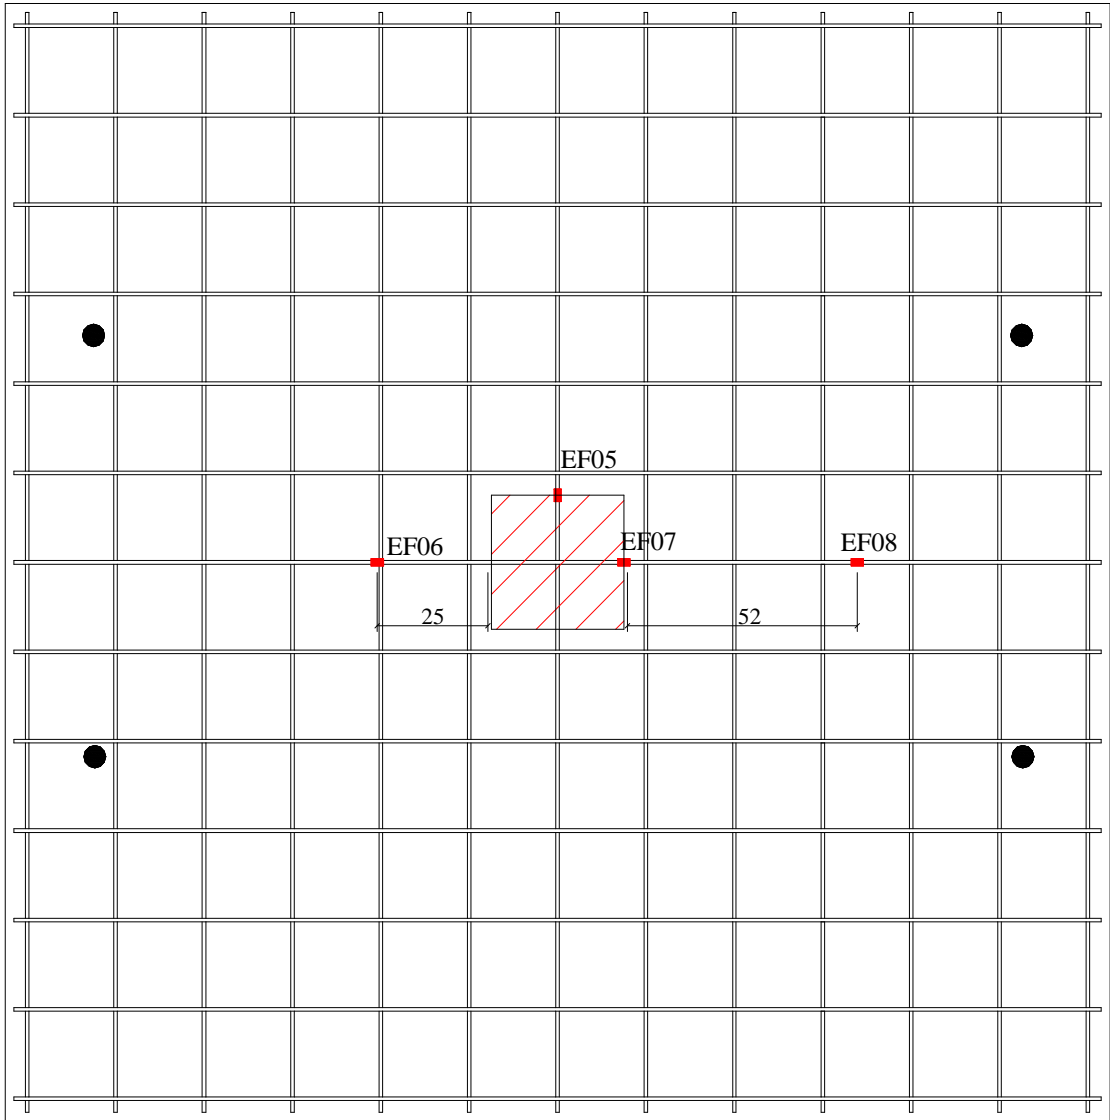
Posição dos extensômetros (Armadura Inferior)
